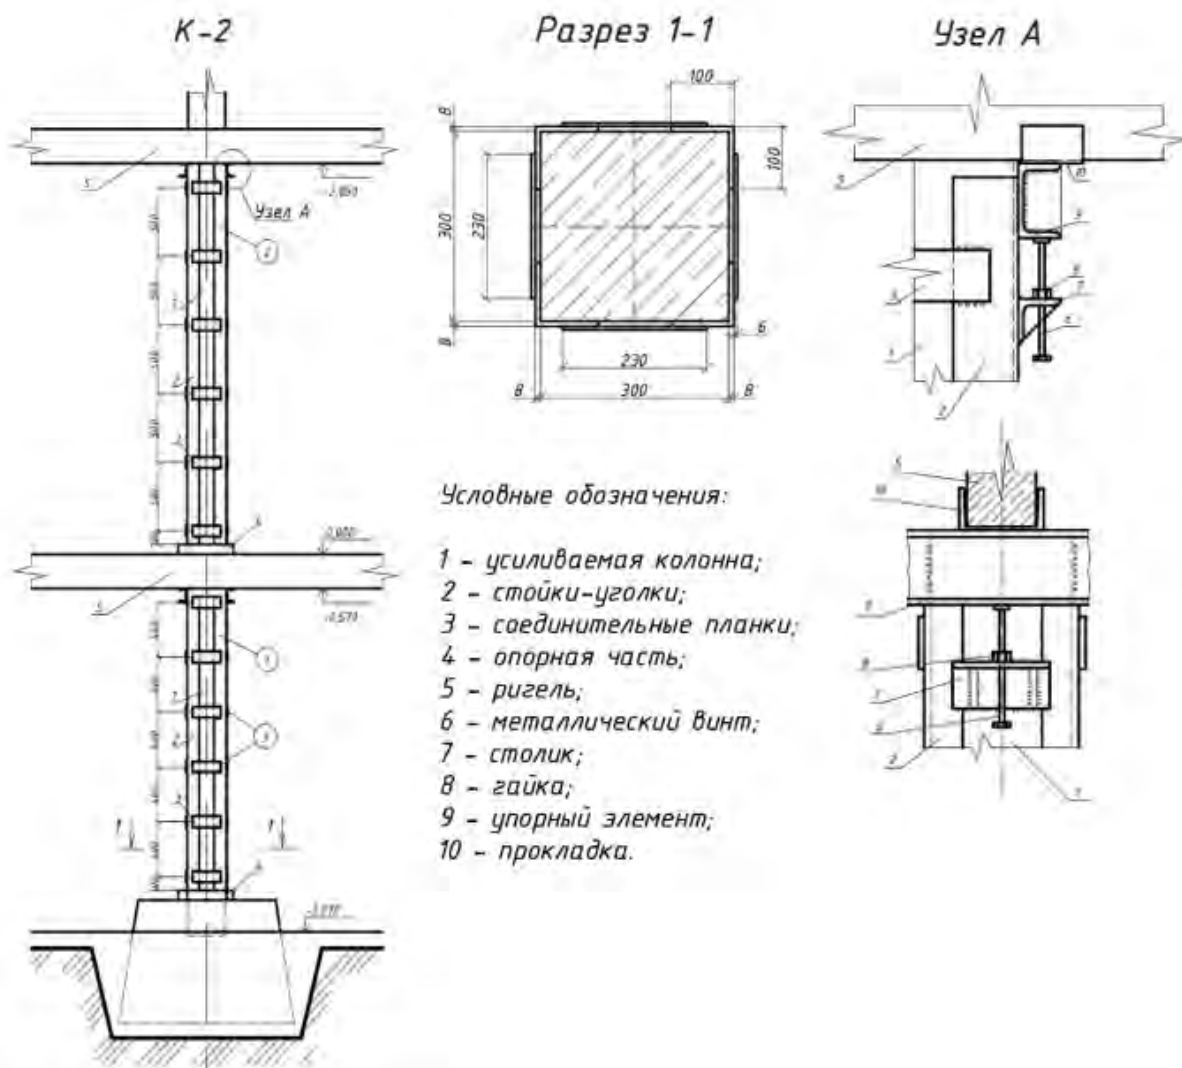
Проект усиления железобетонной колонны металлической обоймой
